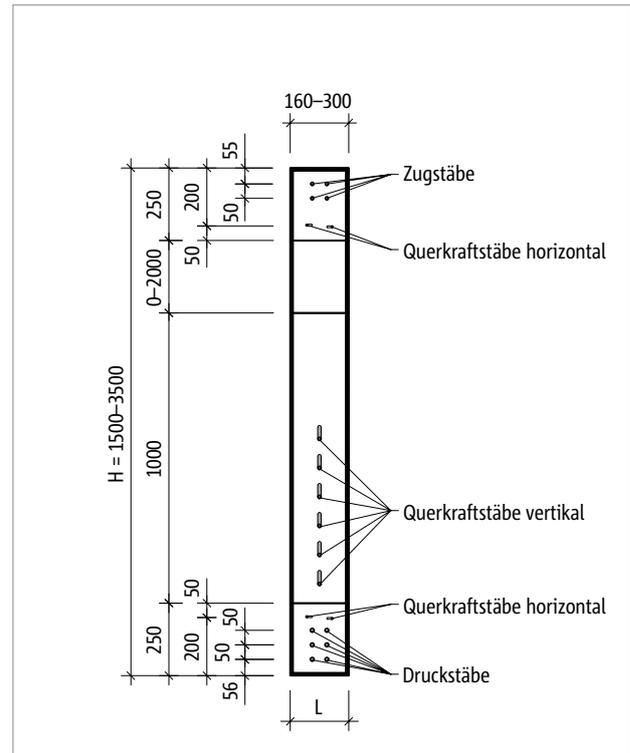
Schöck Isokorb® T Typ W-M4-R90: Produktansicht; Brandschutzplatten umlaufend
